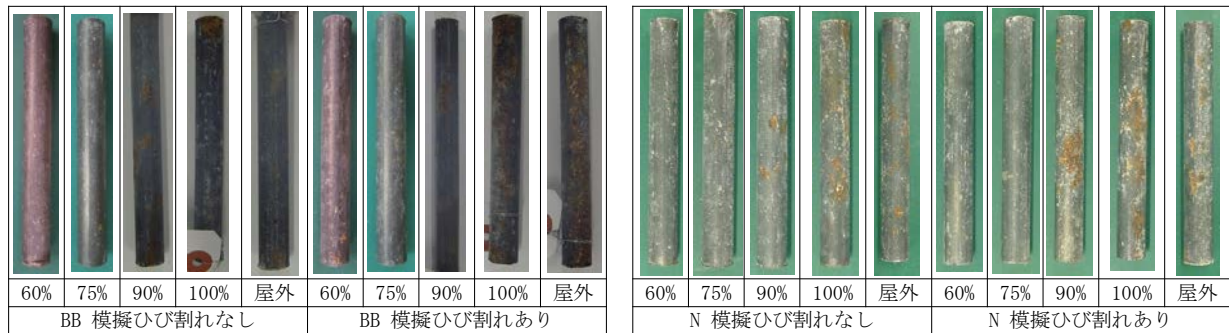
暴露試験期間終了時の鉄筋腐食状況 (BB, N/模擬ひび割れなし, あり)
